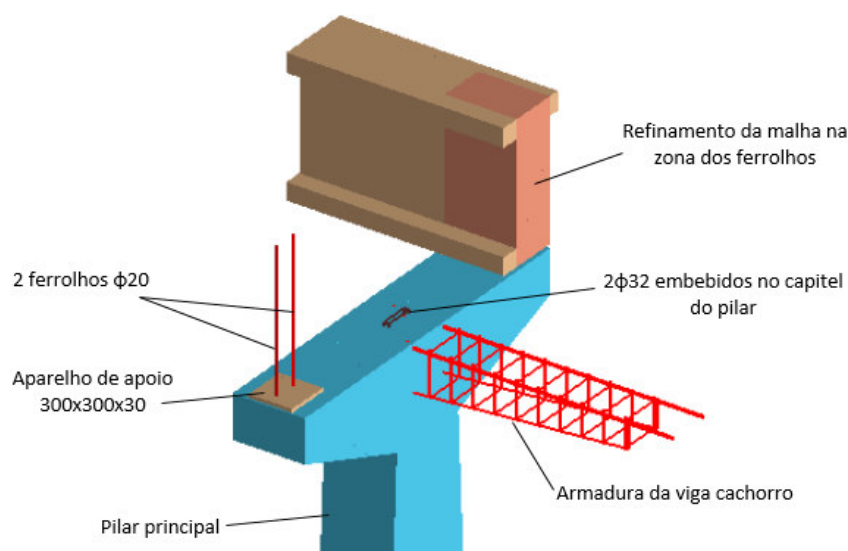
Modelação da ligação entre pilar principal e vigas do tabuleiro.
